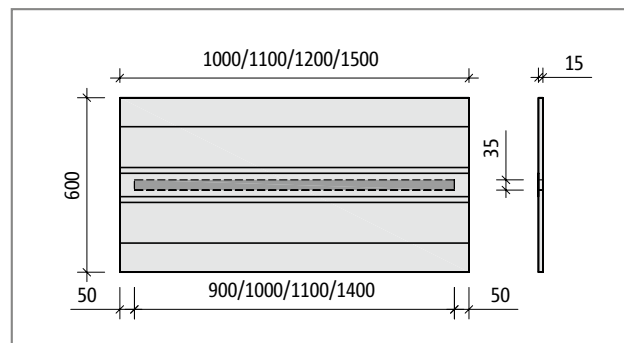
Schöck Tronsole® Typ B-V2-L...-B600: Produktgrundriss
